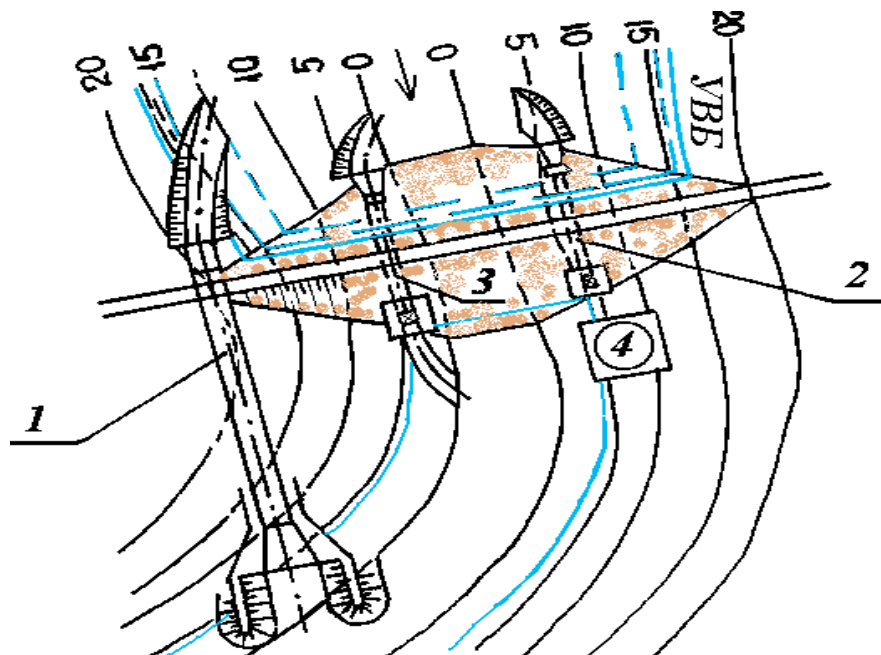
Компоновка низко (и средненапорных) гидроузлов с плотиной из грунтовых материалов с открытым водосбросом, водоспуском и водовыпуском: 1 - береговой водосброс; 2 - водовыпуск; 3 - донный водоспуск; 4 - насосная станция
